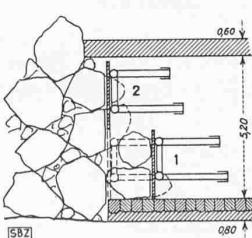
, 1:50 Ringweiser Abbau in der Einbruchstelle
